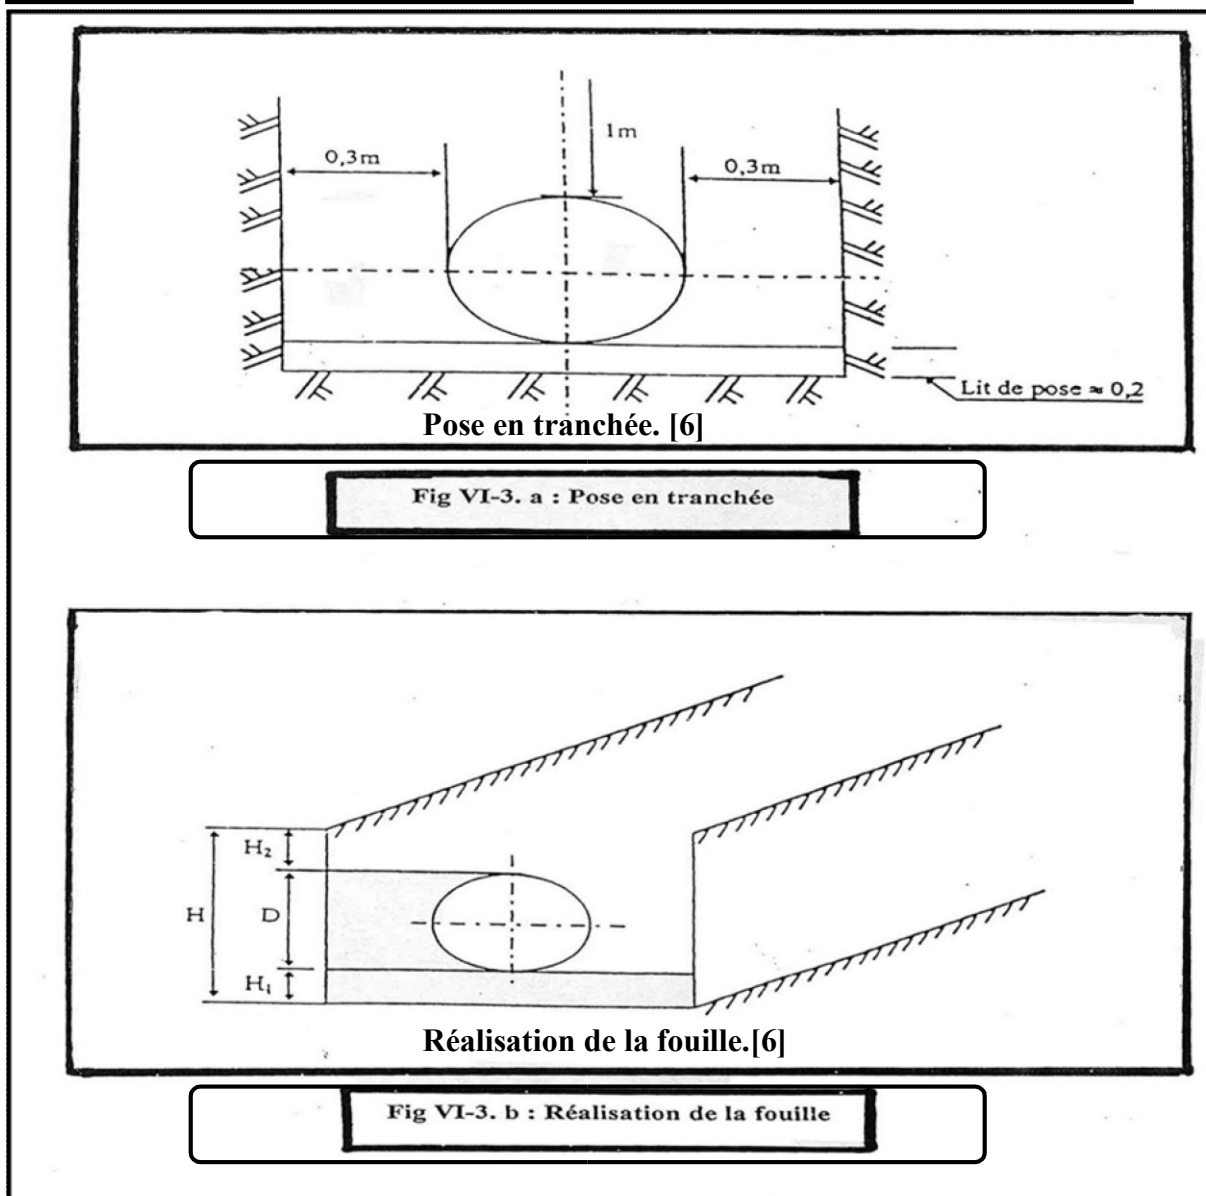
Schéma d'une tranchée avec une conduite circulaire.
